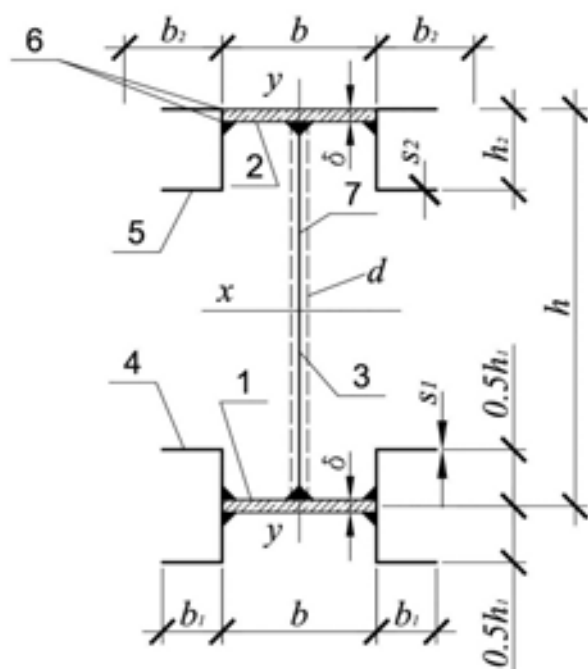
Сварной двутавр стальной балки, полки которого оборудованы гнутыми стальными швеллерами – элементы каркаса термоизоляционного пояса (обогрев поперечного сечения стальной балки с трех граней): 1 – растянутая полка; 2 – сжатая полка; 3 – гофрированная стенка; 4 – швеллеры растянутой полки; 5 – швеллеры сжатой полки; 6 – сварной шов; 7 – антикоррозионное покрытие сварного двутавра; $h_1 \times b_1 \times s_1$ – высота, ширина и толщина гнутого швеллера, прикрепленного к растянутой полке сварного двутавра стальной балки; $h_2 \times b_2 \times s_2$ – высота, ширина и толщина гнутого швеллера, прикрепленного к сжатой полке сварного двутавра стальной балки; d – толщина гофрированной стенки, мм
